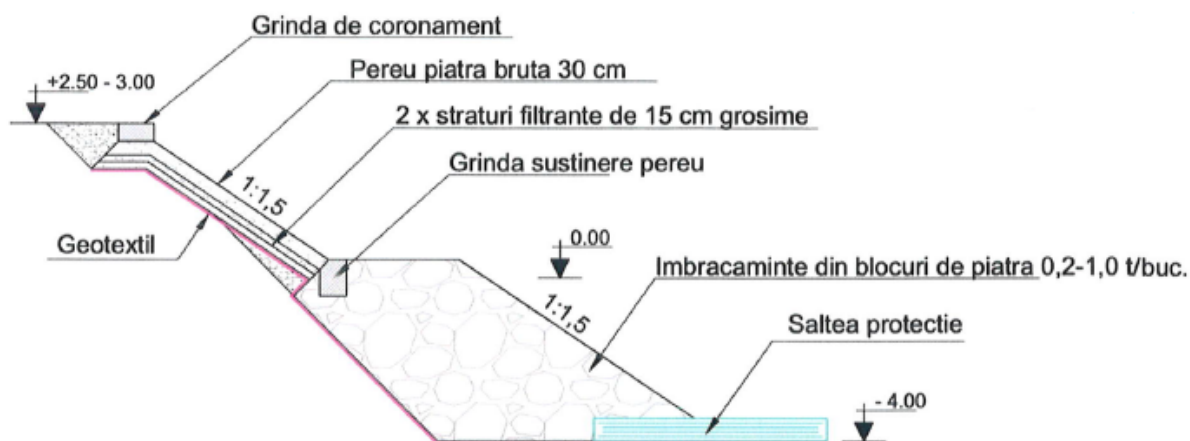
Soluție constructivă 1 pereu zidit din piatră brută
